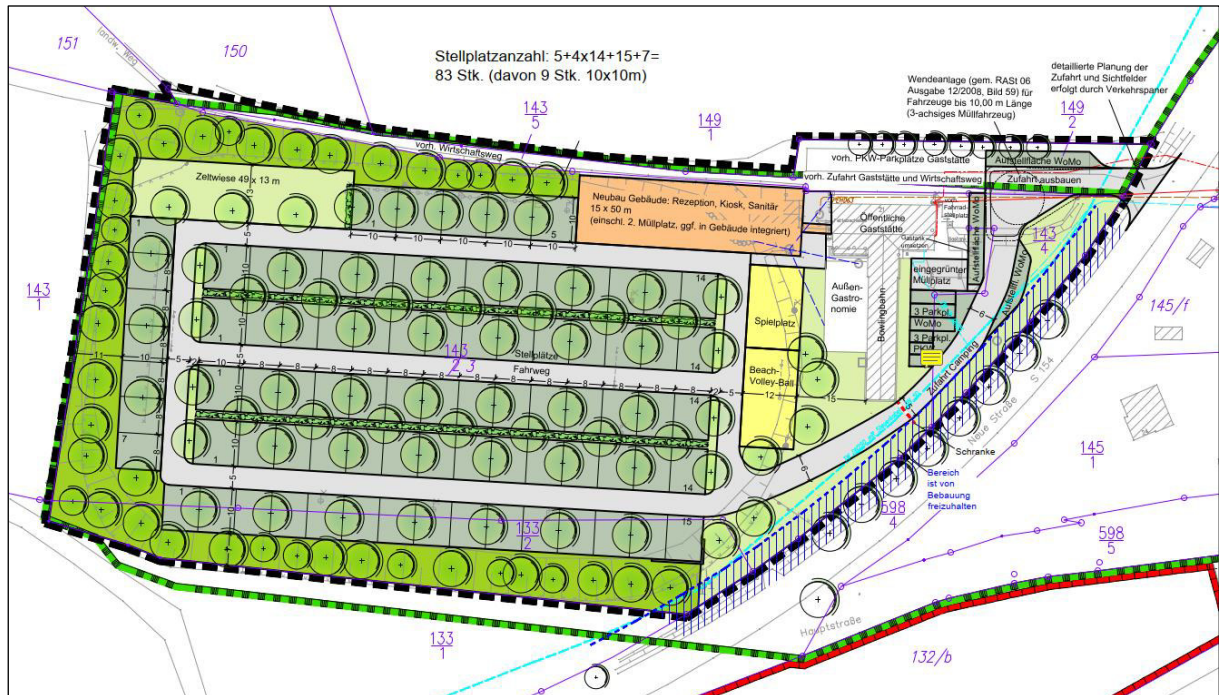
Lageplan Städtebauliches Konzept (Stand 10.10.2024, BÜRO FÜR LANDSCHAFTSARCHITEKTUR HÜBNER)
